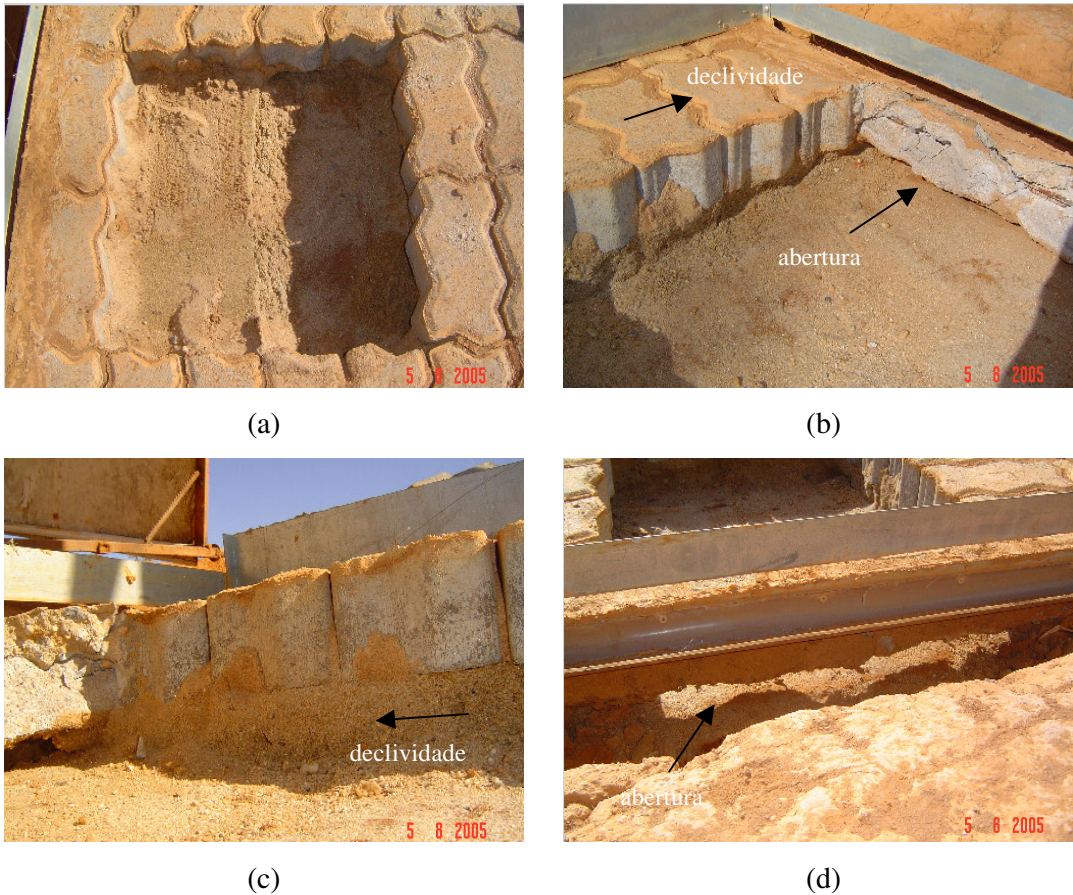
Parcela BMC6 (a) vista superior da areia abaixo dos blocos; (b) encontro da camada de areia com a cinta de concreto e aparecimento de uma abertura; (c) camada de areia próxima à abertura; (d) detalhe da escavação abaixo da calha e aparecimento da abertura.
